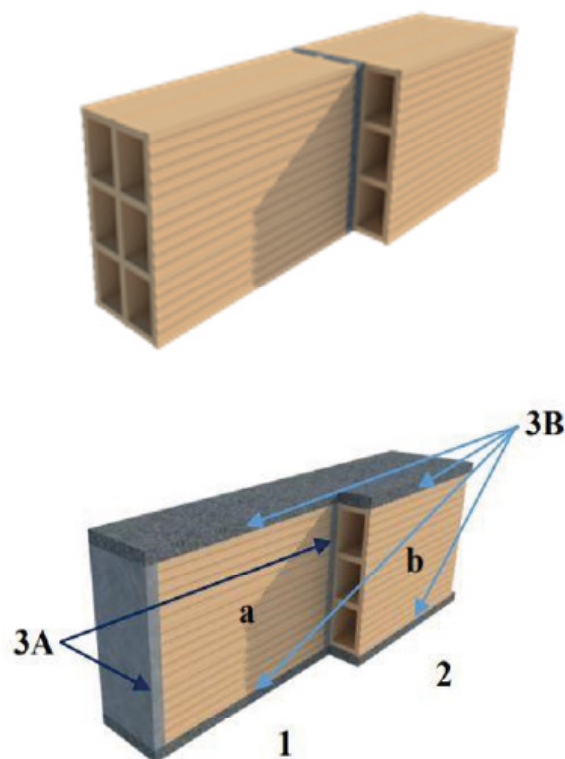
Patrón constructivo: (1) Bloque H-10 estándar, (2) Bloque H-15 estándar y (3) Junta de mortero estándar.
